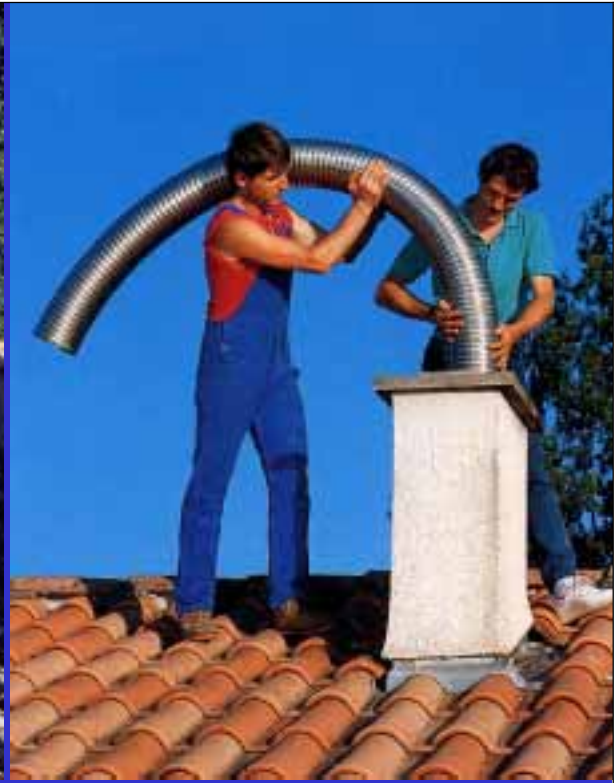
B: Entubado interior de chimenea existente, con inoxidable de simple pared flexible. Fabricante PUJOLAT.
